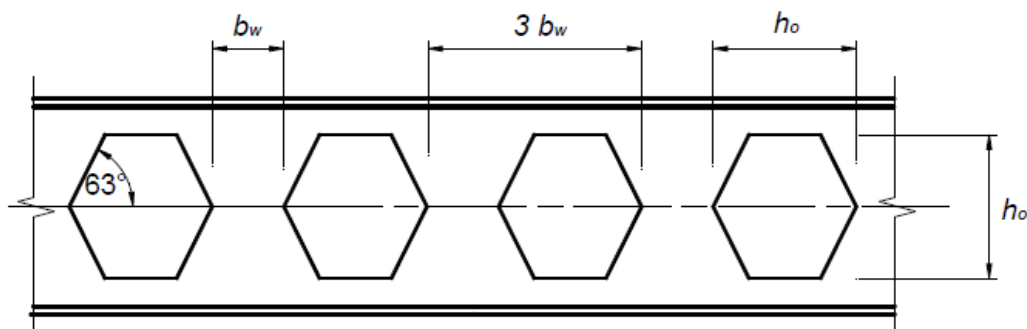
Geometria de vigas casteladas em padrão Peiner
